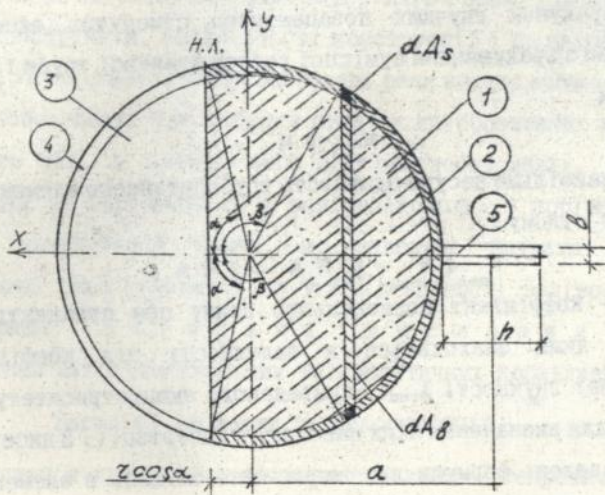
Розрахункова схема поперечного перерізу карнизного вузла
